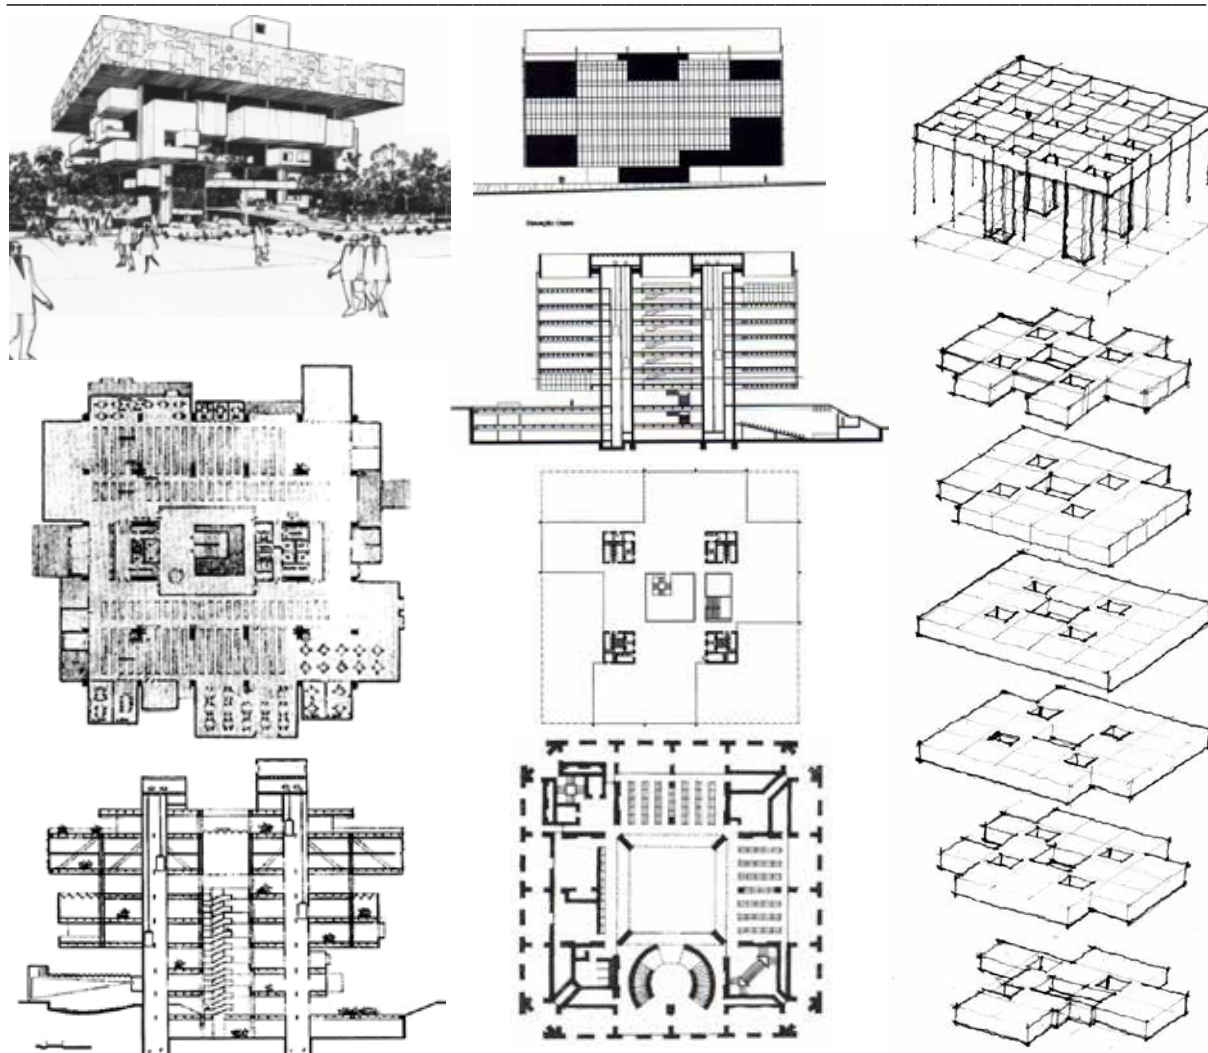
(coluna esq.): 3º prêmio concurso Biblioteca da Bahia (1968): perspectiva; planta 3º pavimento e corte.
